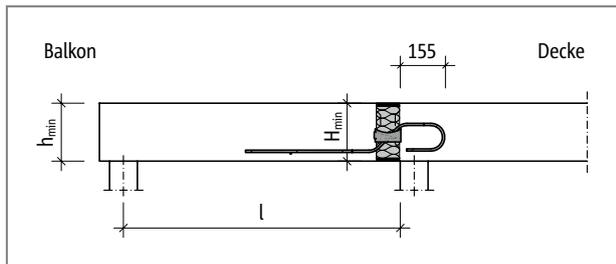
Schöck Isokorb® T Typ QL-V1 bis QL-V3: Statisches System
